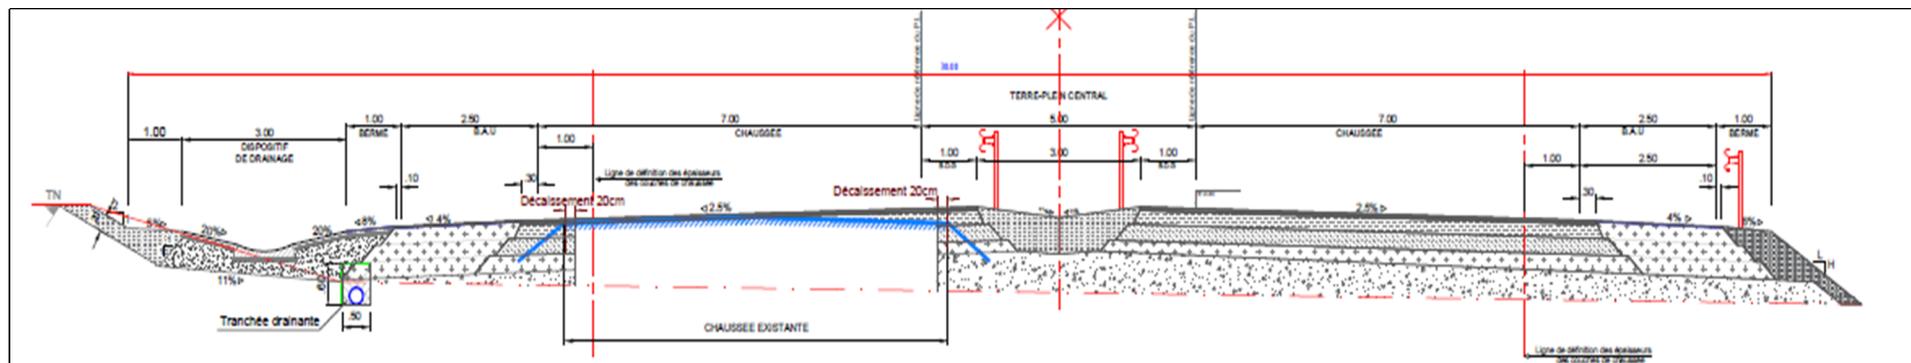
Profil en travers type dans le cas d'élargissement de chaussée existante unilatérale (Droite ou Gauche)
